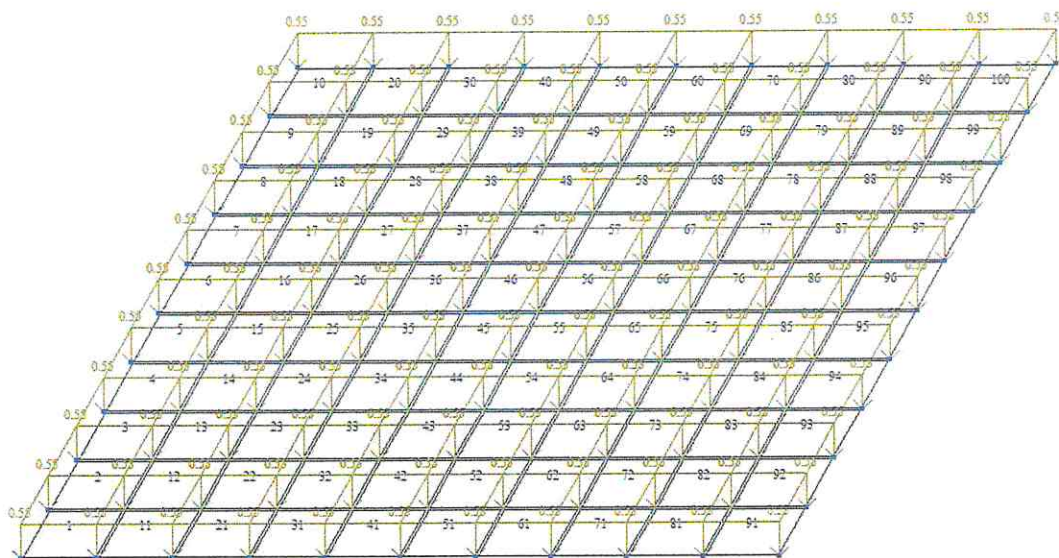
Нагрузка на плиту перекрытия лифтовой шахты от собственного веса плиты перекрытия.
